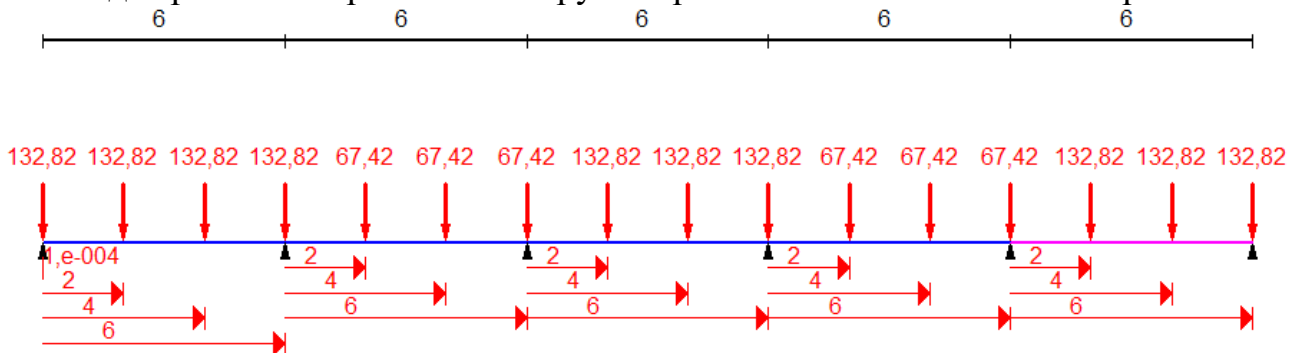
Расчётная схема главной балки, когда временная нагрузка приложена на нечётные пролёты
